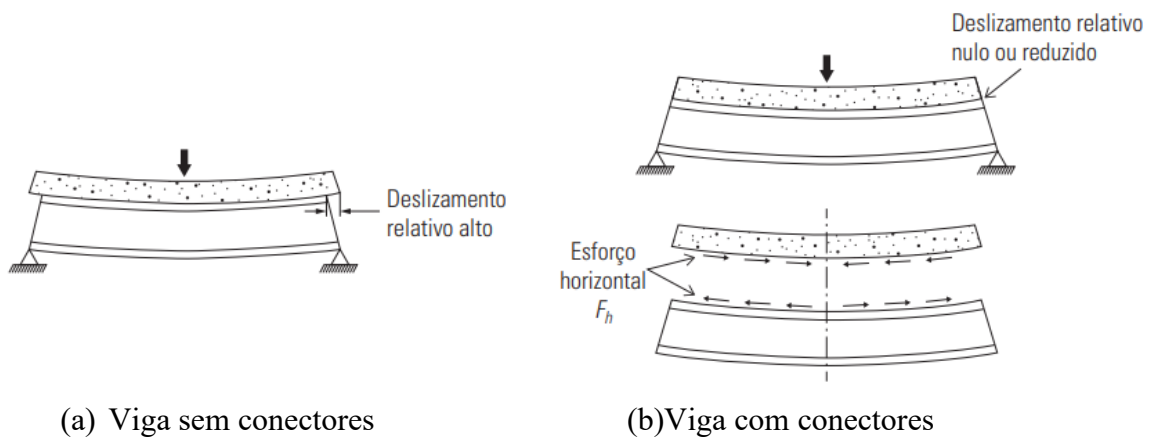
Ilustração de uma viga mista de aço-concreto (FAKURY, 2016)
